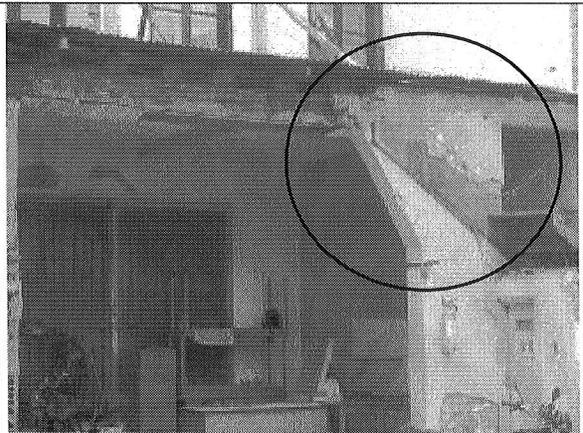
Muros de la construcción de la zona frontal en malas condiciones.
